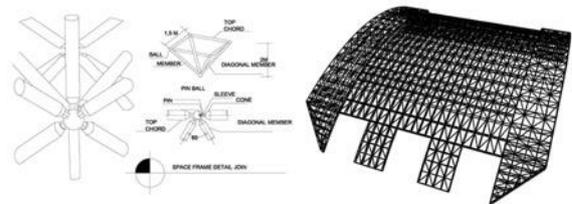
Struktur space frame atap dan fasad. Sumber: penulis
